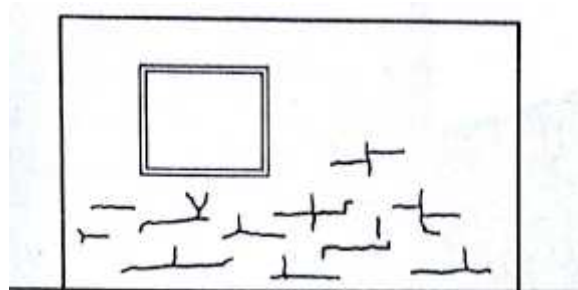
Fissuras horizontais provocadas pela expansão da argamassa de assentamento.
